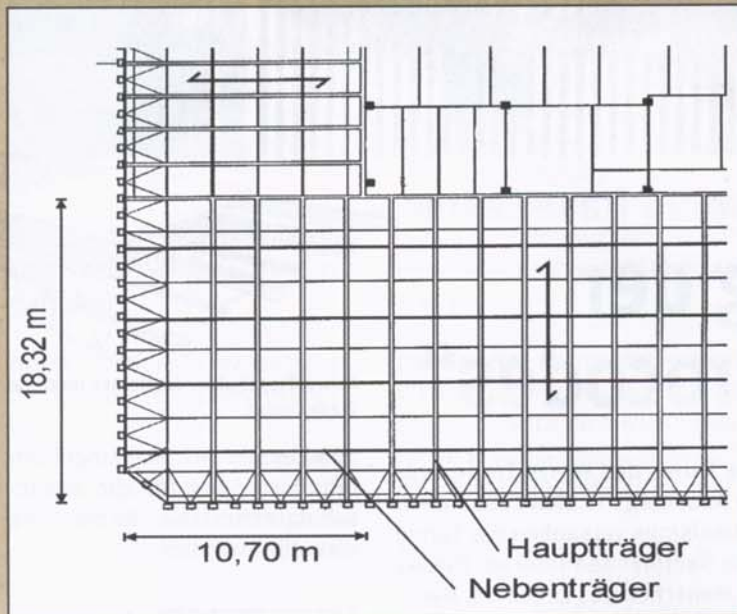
Viertel-Grundriss eines Regelgeschosses [1].
